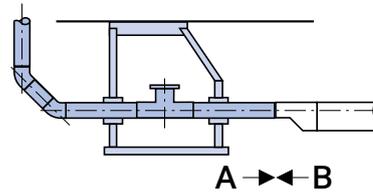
Aufweitung nach einem Einstiegsschacht ist erlaubt
